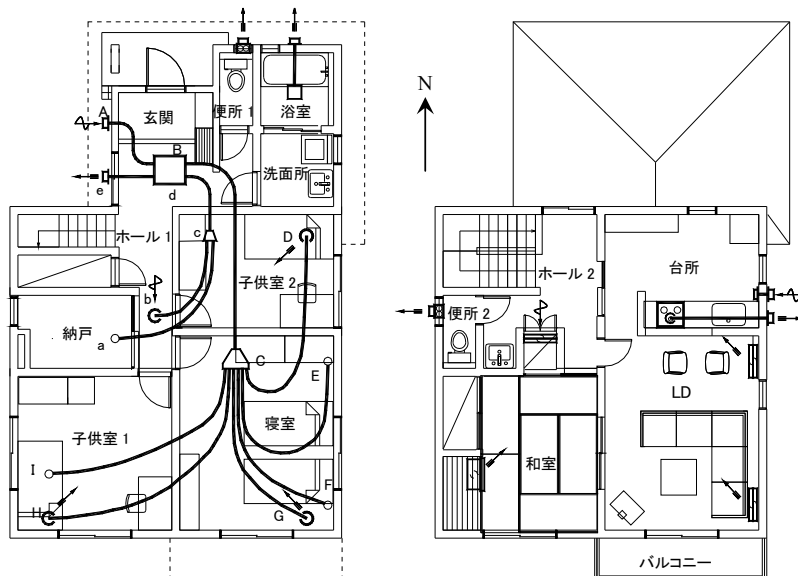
平面図兼換気設備図(左側1階、右側2階)
